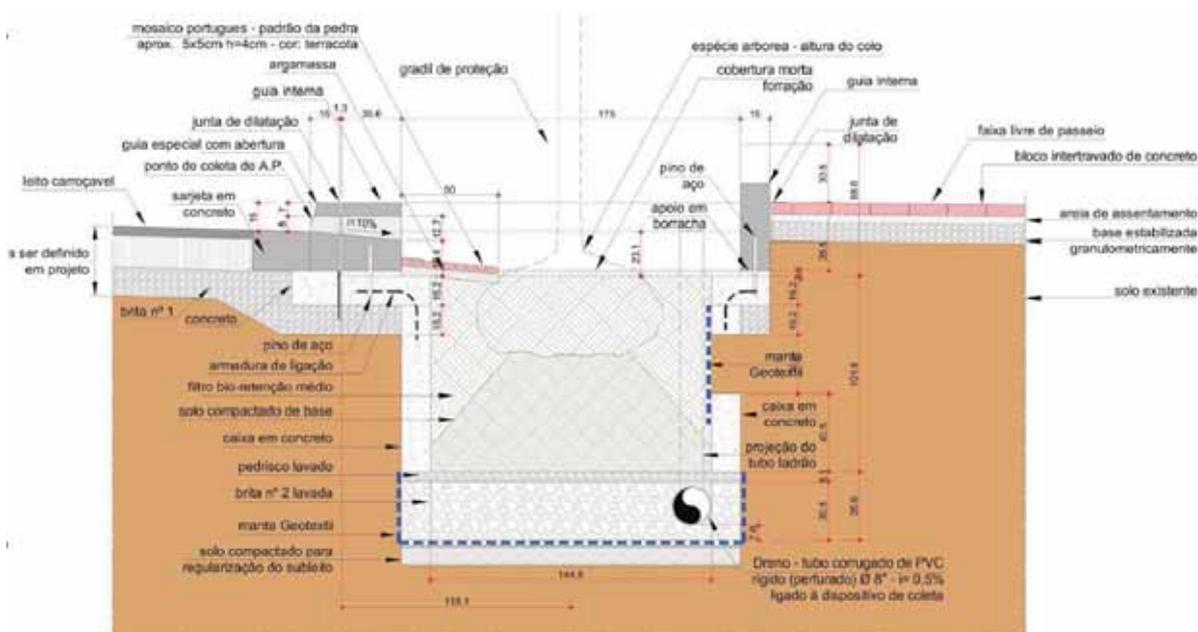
CORTE TÍPICO DE CHUVA ADOTADO PELO PUE
